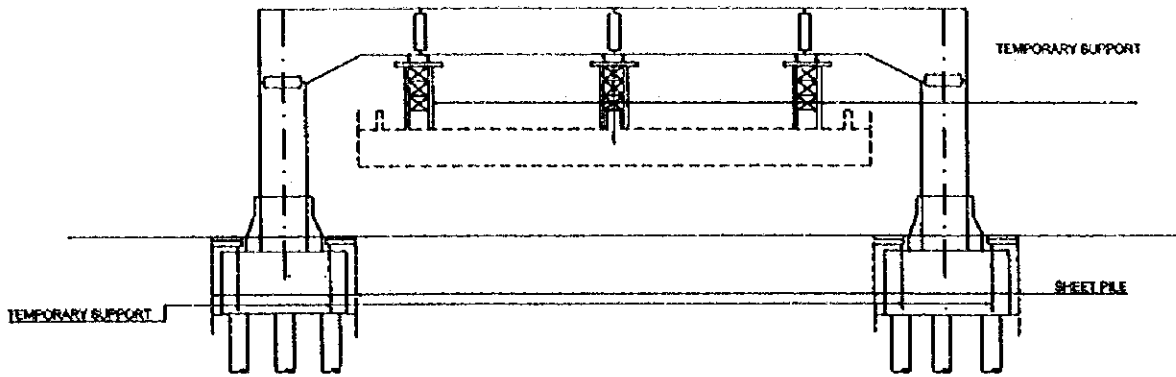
Autopista de Anillo Interior - Viga y Columnas de Acero
